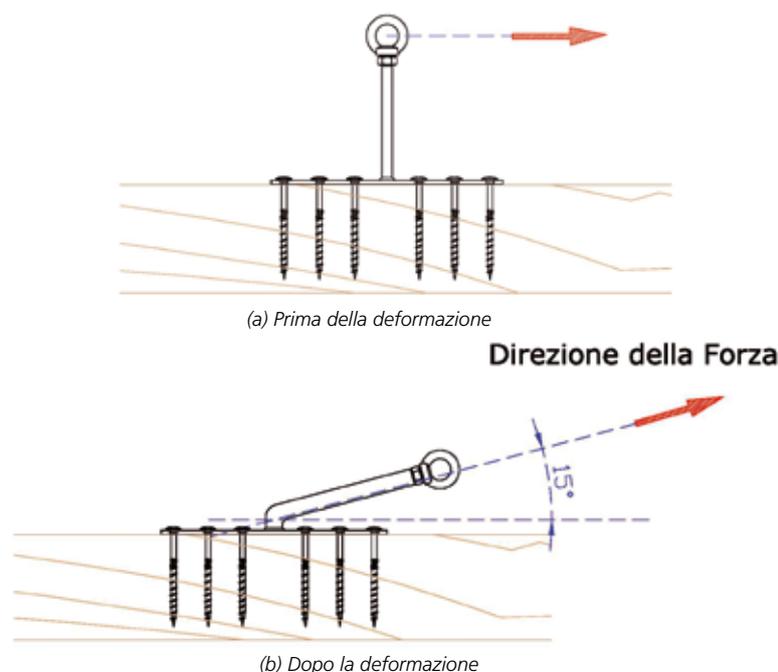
Direzione della forza applicata sul dispositivo di ancoraggio.
